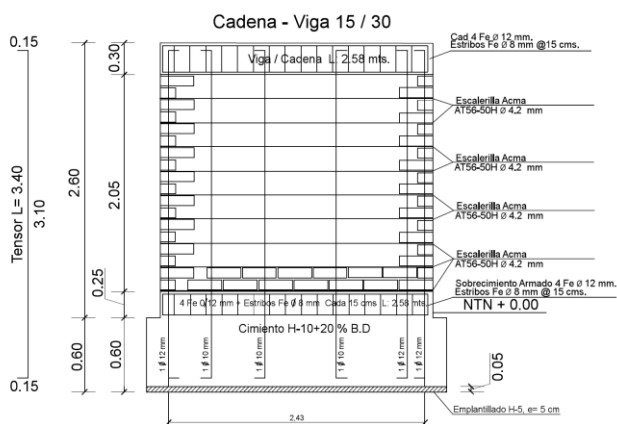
Elevación estructural de un muro de albañilería en la vivienda de estudio.
